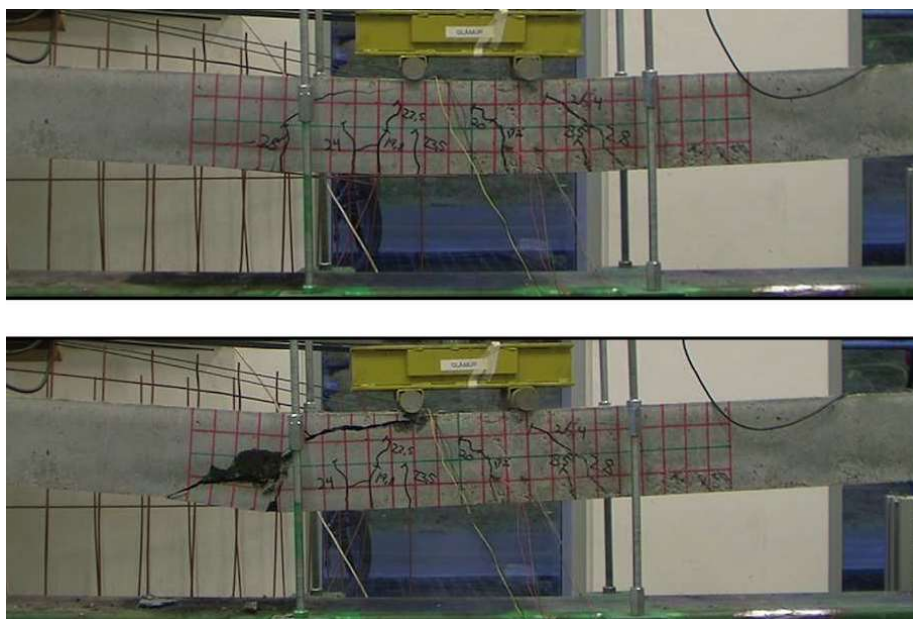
Comportamiento de fisuración en la viga al momento de la falla – Ensayo real ABS_A4
